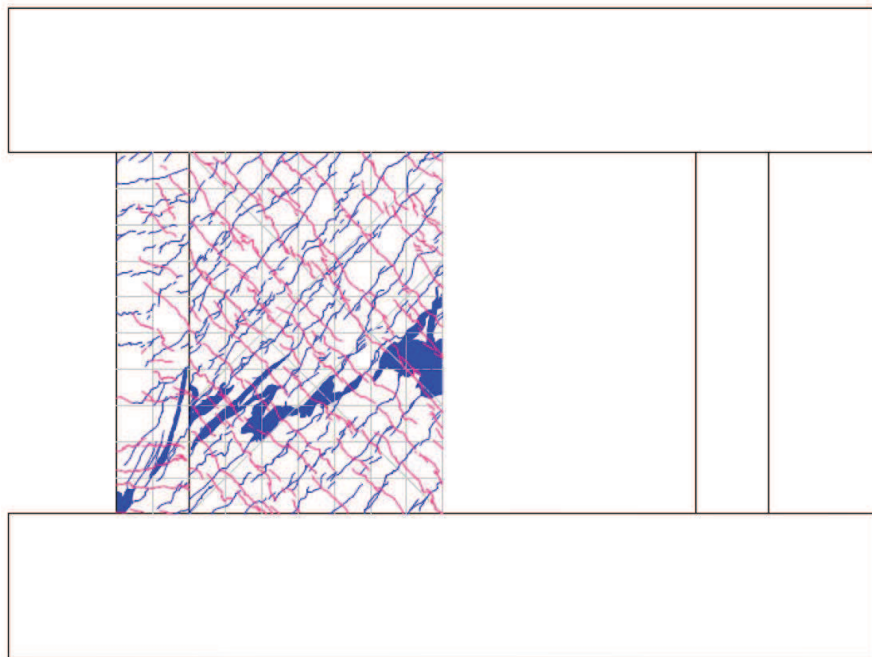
試験体 S-13-D I 最終破壊時ひび割れ図
